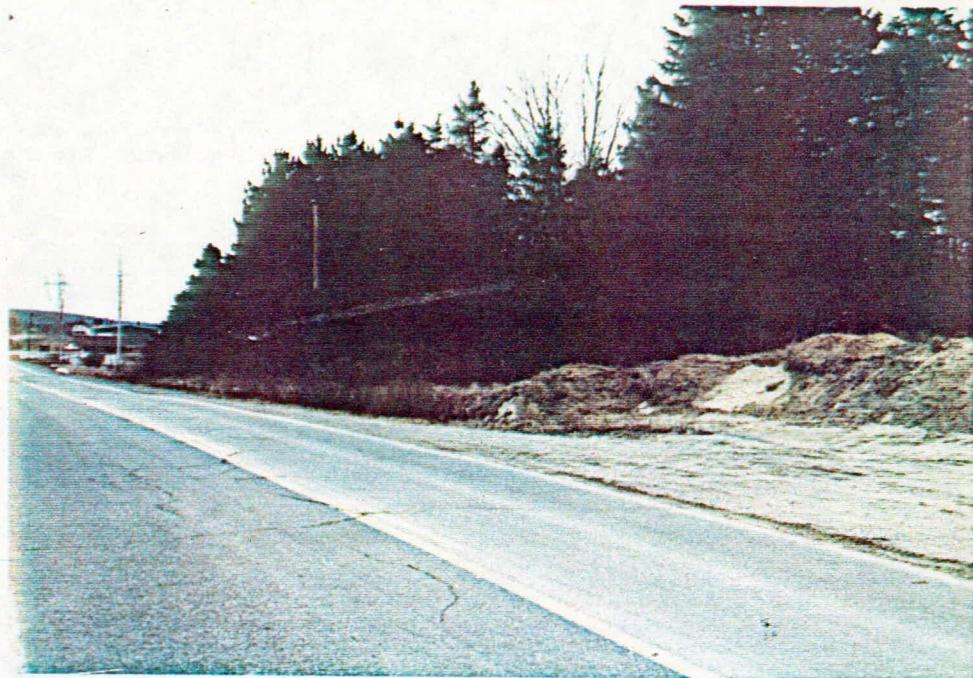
Vue d'un boisé de sapins baumiers situé entre les chaînages 13+023 et 13+103.
